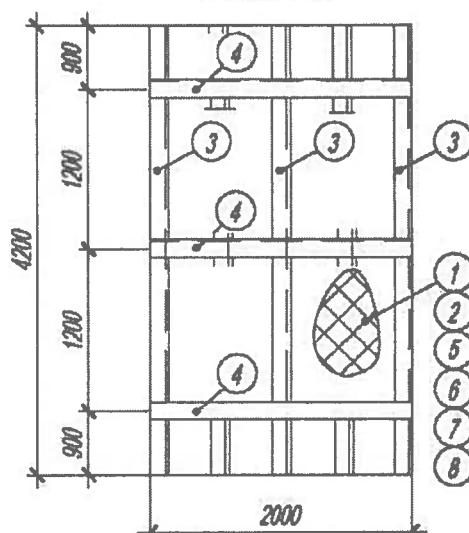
Схема конструктивного исполнения опытного образца конструкции междуэтажного перекрытия.
